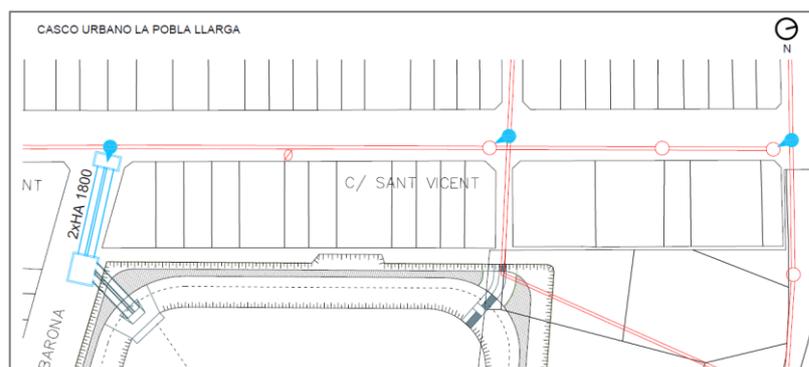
Planos de actuaciones sobre la red de alcantarillado existente
